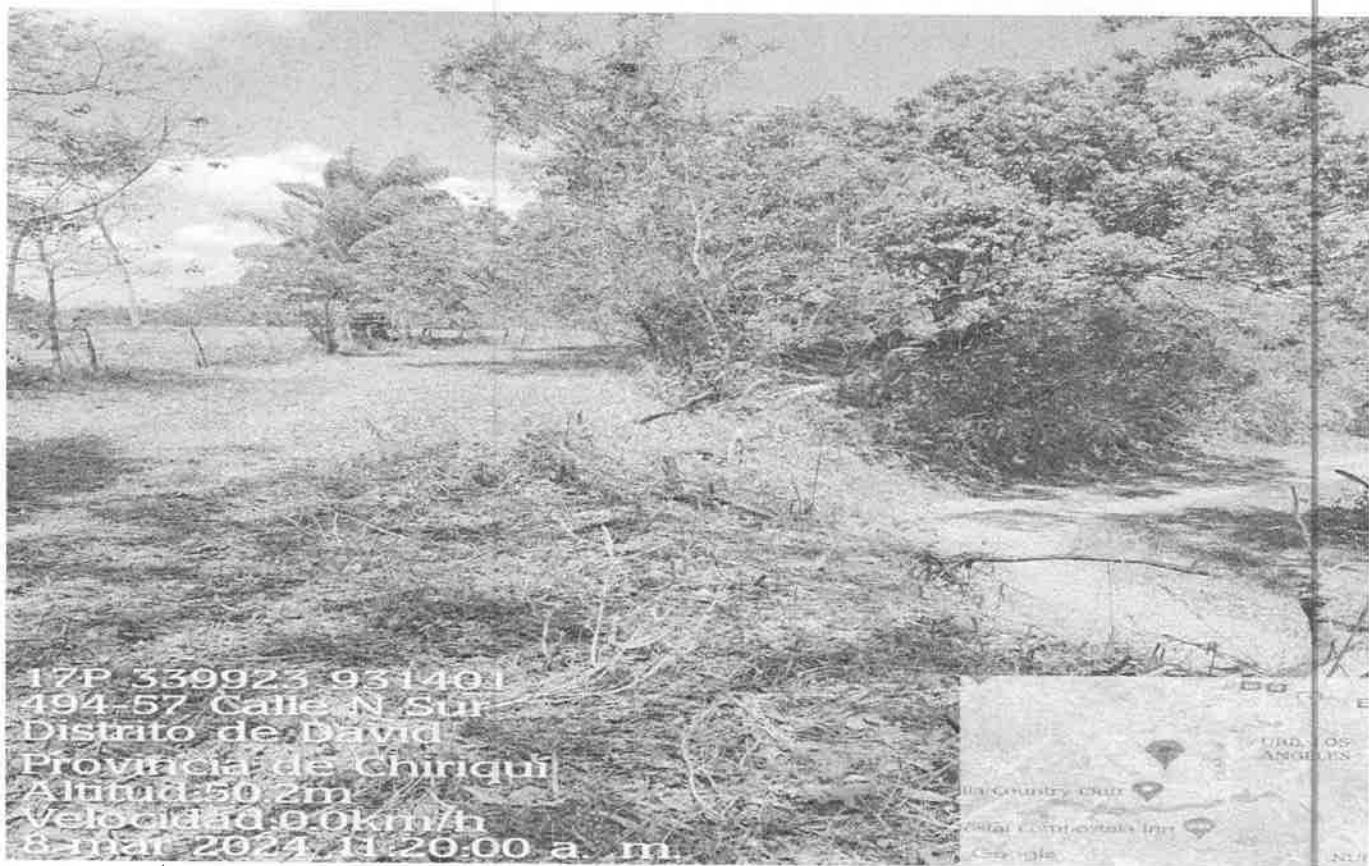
Área más alta de los polígonos de intervención donde se realizarán trabajos de cortes y banquetas
